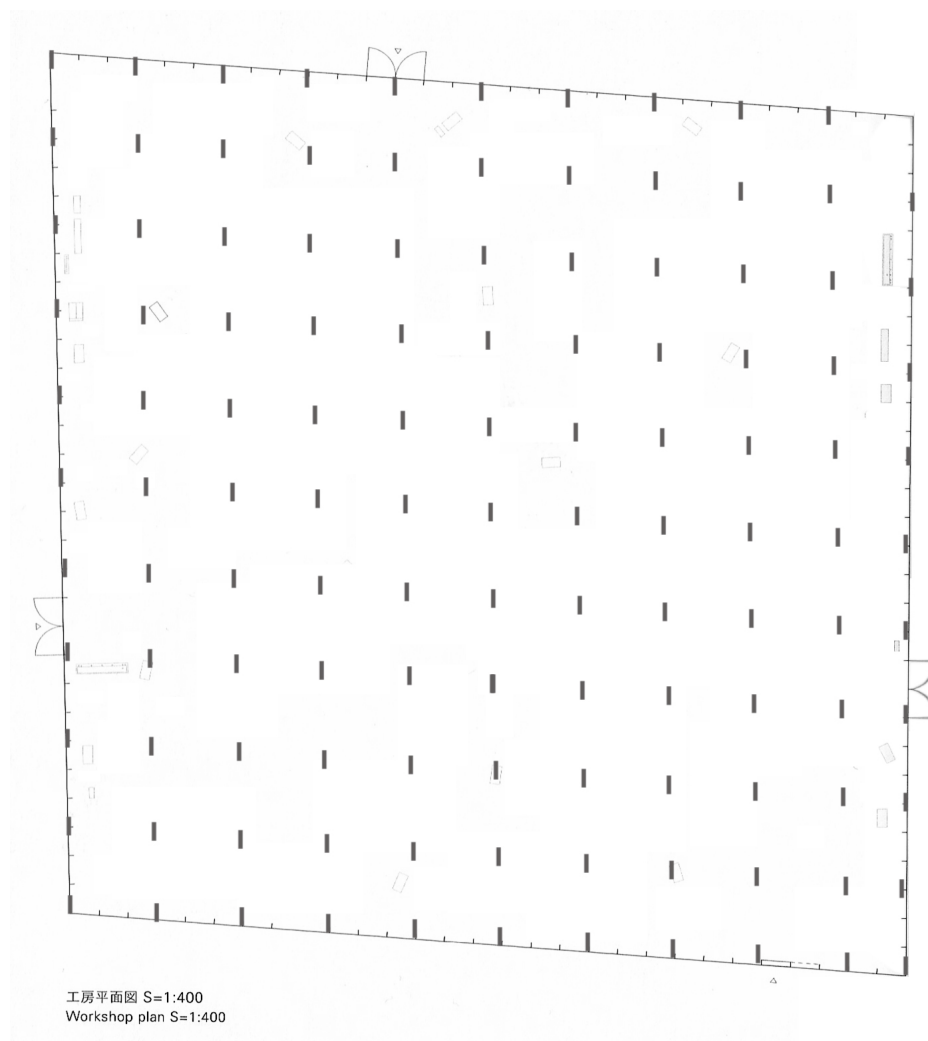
Forma que tendría la planta del KAIT con 120 pilares trabajando a compresión.
